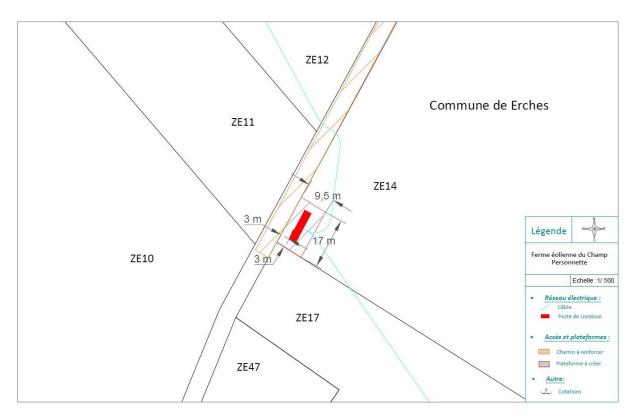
Plan du poste de livraison 11 m x 2,5 m
